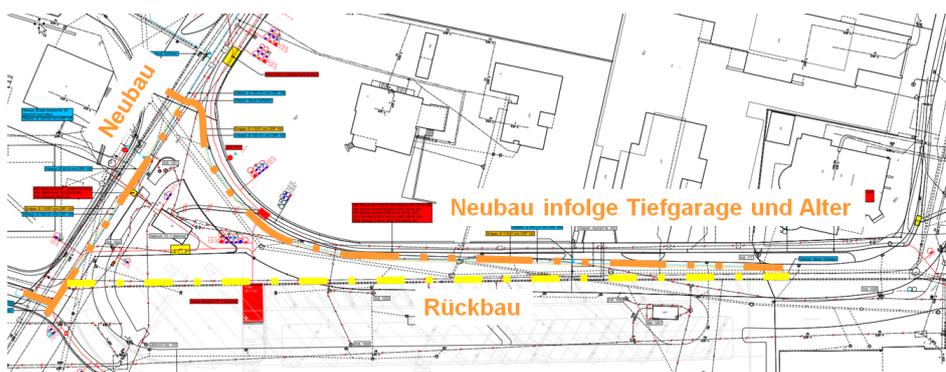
Planausschnitt mit dargestelltem Erneuerungsbedarf Gas
